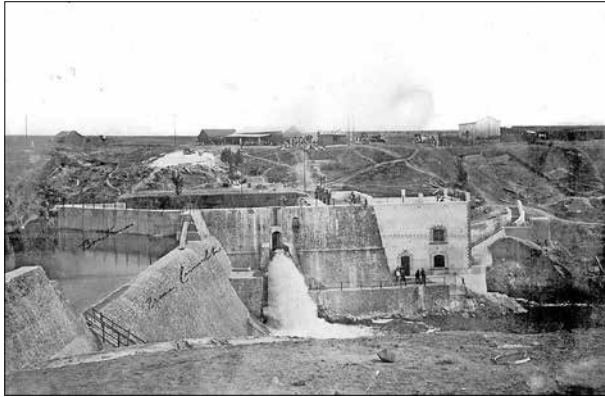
Vista general de la Carmelita en 1917, en la que en un primer plano se aprecia la presa con la casa de máquinas y el campamento al fondo. AHA, AS, c. 4211, exp. 56704, f. 126.
